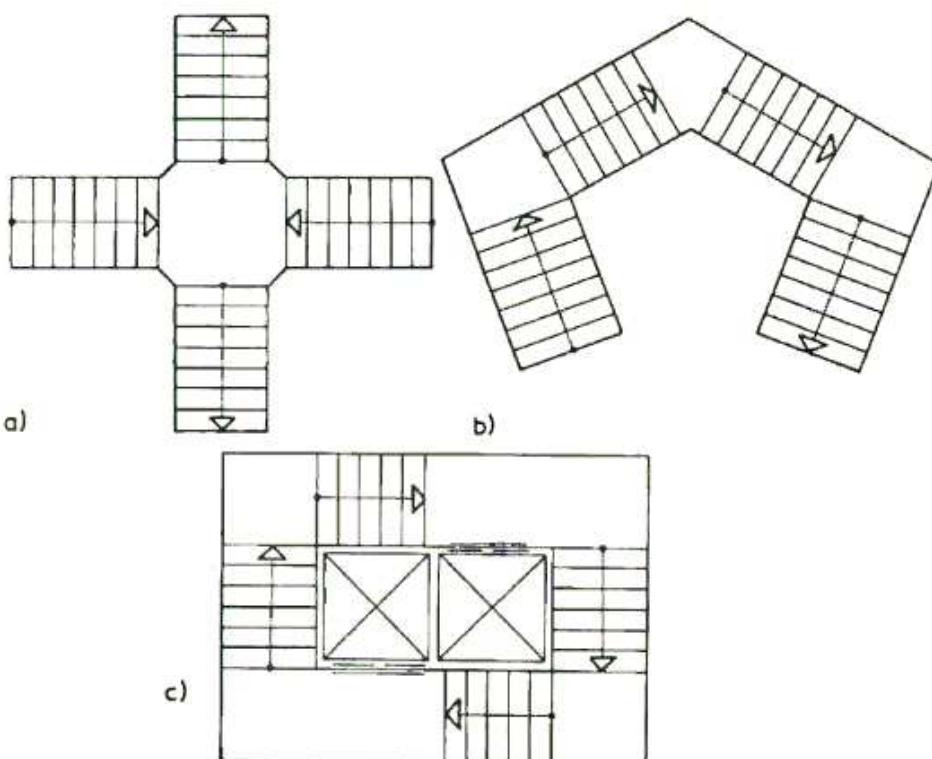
Лестницы четырёхмаршевые: а – прямая, б – крестообразная, с – пятиугольная
